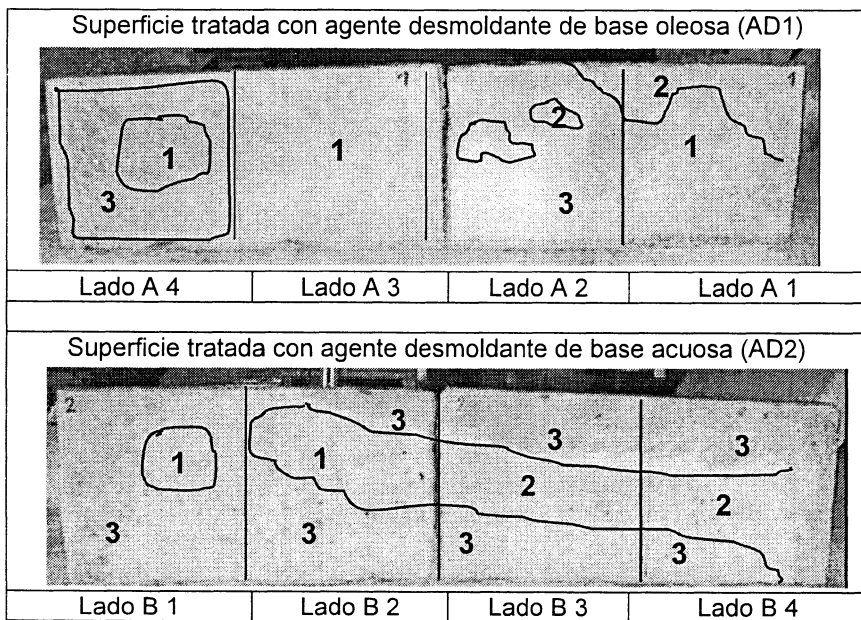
b. Relevamiento de burbujas en el panel llenado con el hormigón H1.
